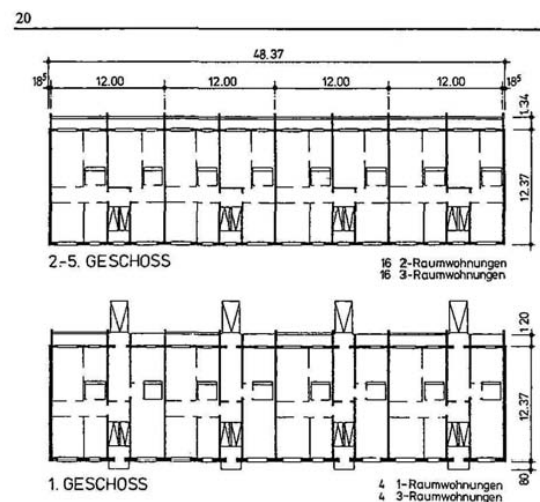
Grundrissbeispiele für WBS 70 5 Etagen
